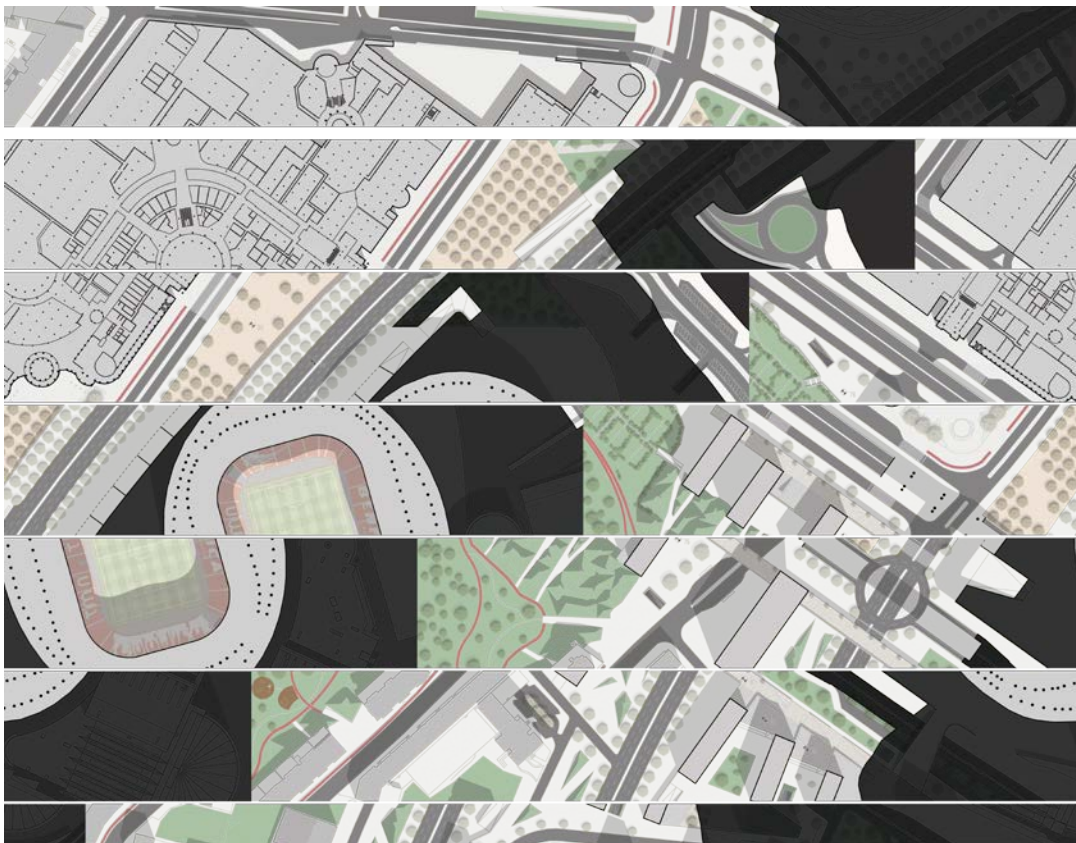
Planta Luz/Colombo cota 82 (Fonte: Autor)
